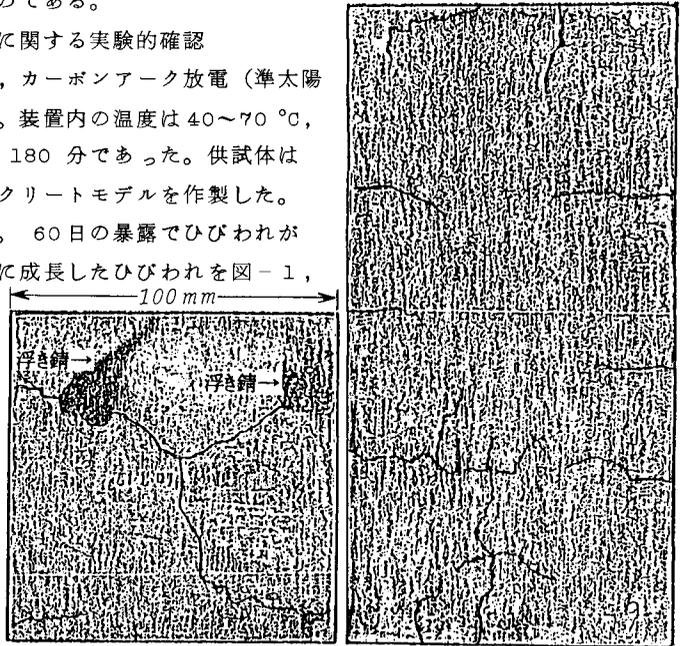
横断面上のひびわれ 図-2 側面上のひびわれ
